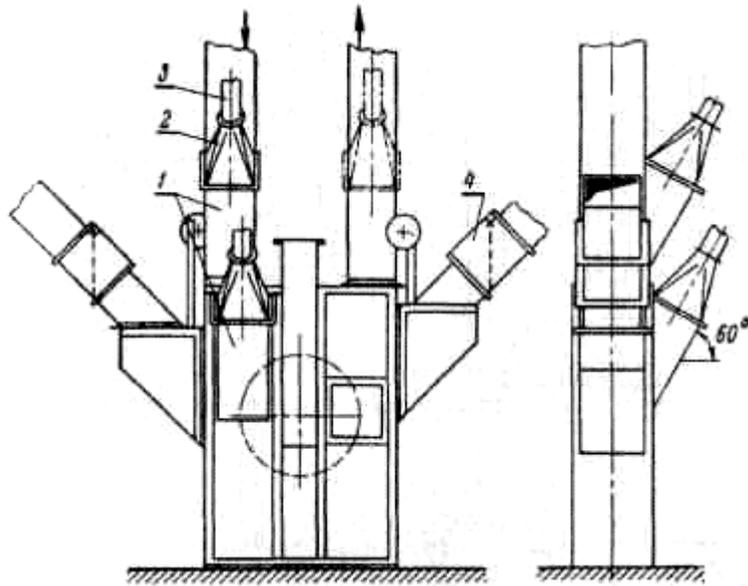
Отсос воздуха от башмака нории: 1 — отвод вентиляционный; 2 — коллектор; 3 — воздухопровод; 4 — клапан противопыльный; пунктиром показан вариант второго отсоса воздуха вместо нижнего его расположения.
